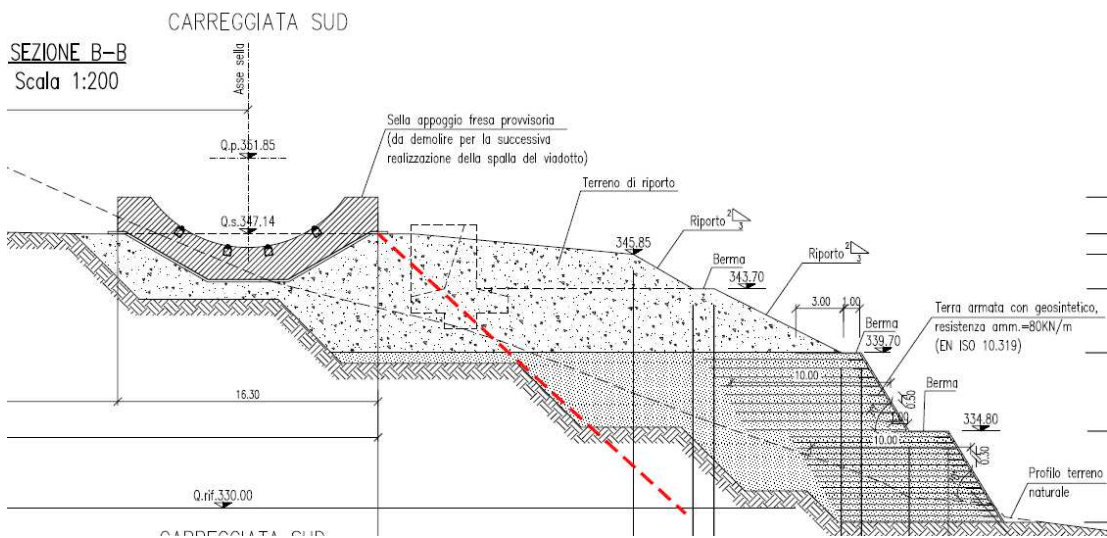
Sezione del rilevato con muro in terra armata alla base
